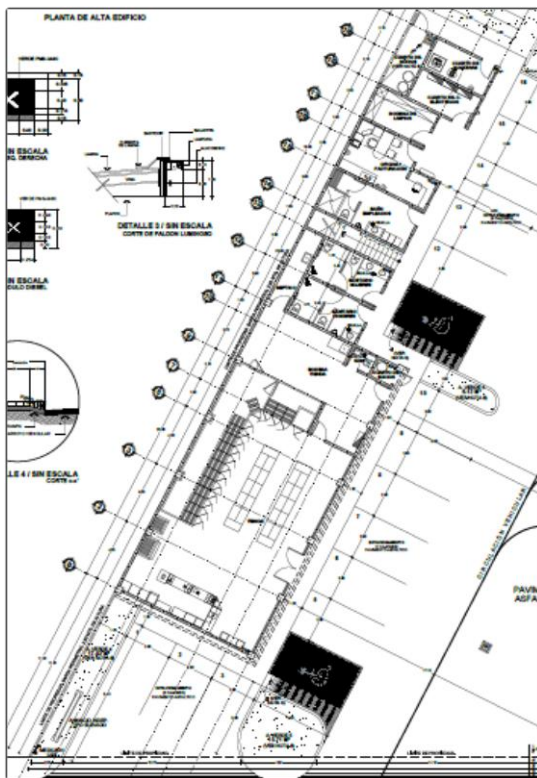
Edificio, Planta Baja y Estacionamiento.
